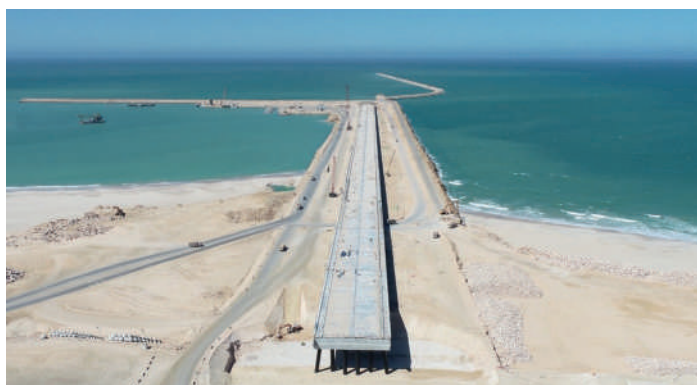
Vista aérea da Ponte de Acesso ao Porto de Dakhla. Aerial view of the Dakhla Port Access Bridge.
